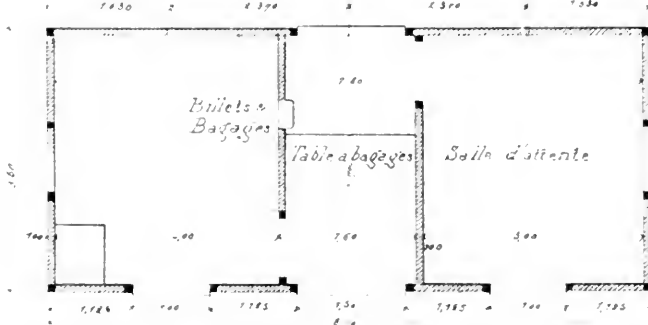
Plan Coupe gh a 0 001 p^r1^m
